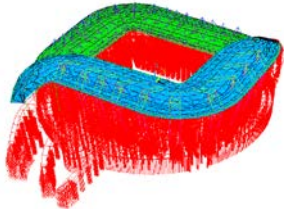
Фрагменты конечноэлементной модели полной системы «основание – железобетонные конструкции фундаментов и трибун – металлические конструкции покрытия» стадиона в Ростове-на-Дону
